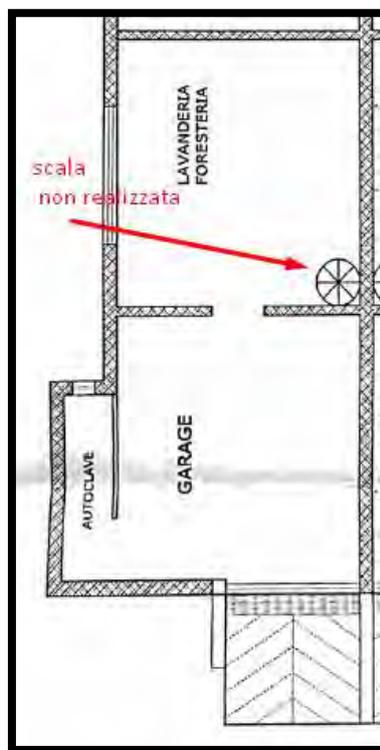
Pianta piano terra allegata alla CILA prat. n. 294/2011
